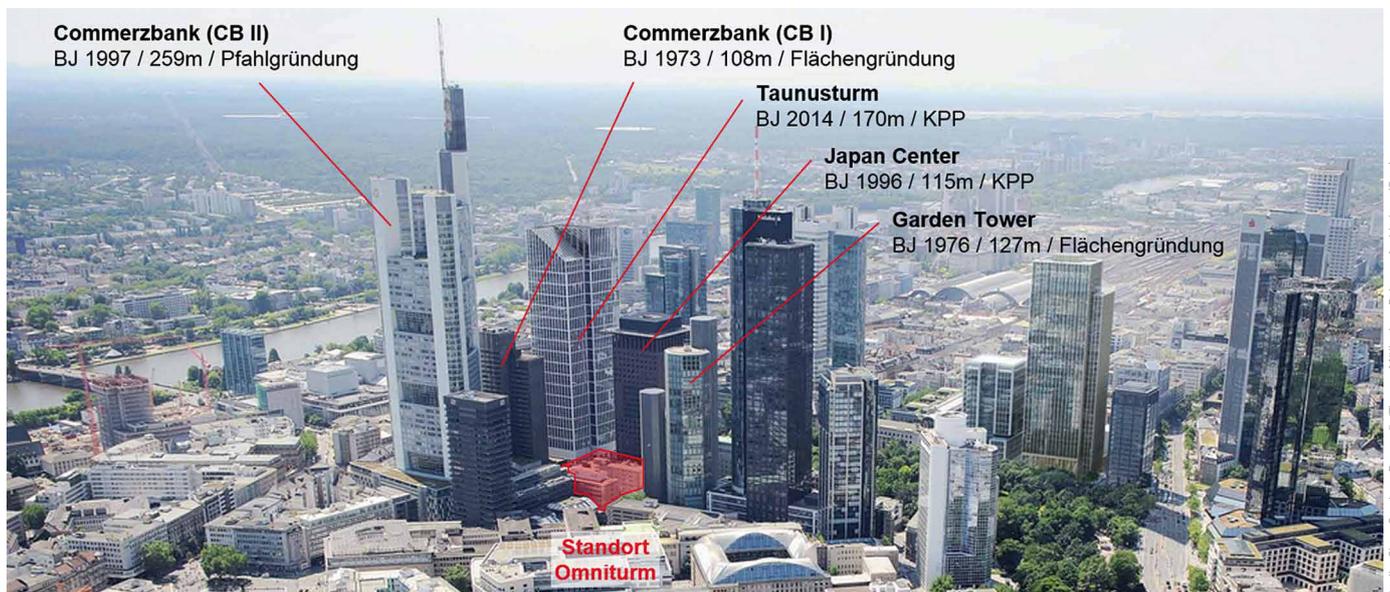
Skyline Bankenviertel Frankfurt am Main, ergänzt um Angaben zur Nachbarbebauung
